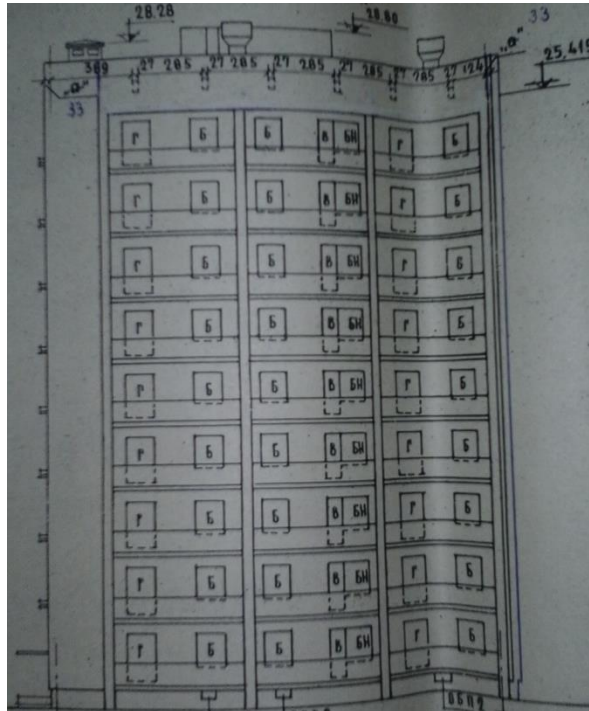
Вариант фасада дома с перекрытием лоджии 9-ого этажа на отметке плит покрытия дома
